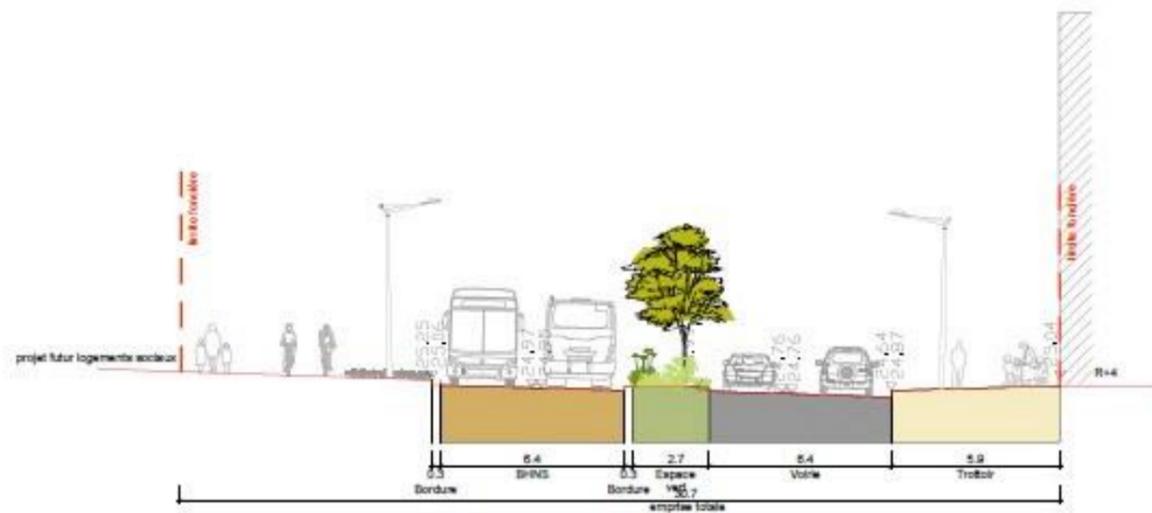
Coupe type sur l'avenue de la Mission Haut-Brion en section courante
